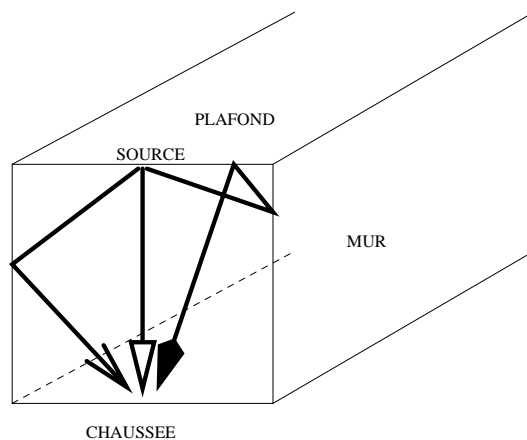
Influence de la chaussée, des murs, du plafond sur les niveaux de luminance de la chaussée
